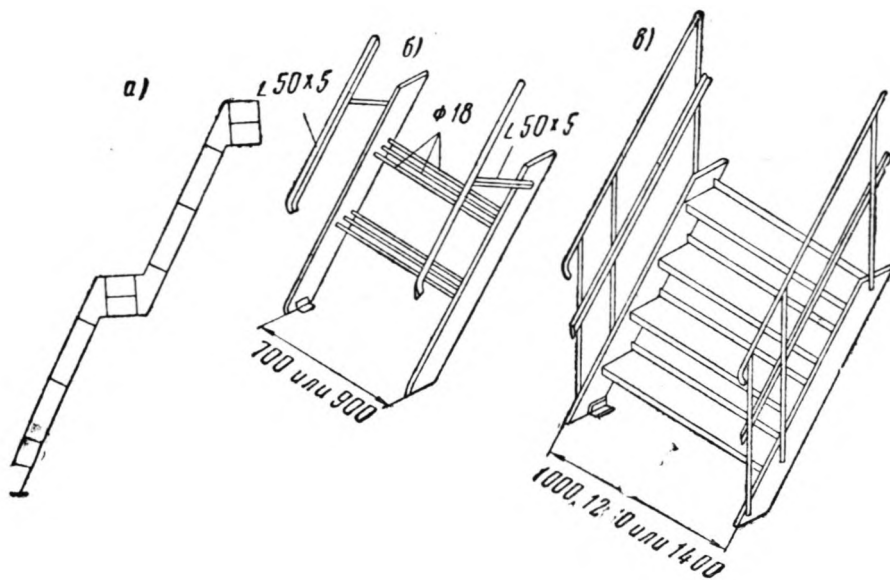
Лестницы на рабочих площадках промышленных зданий и сооружений
